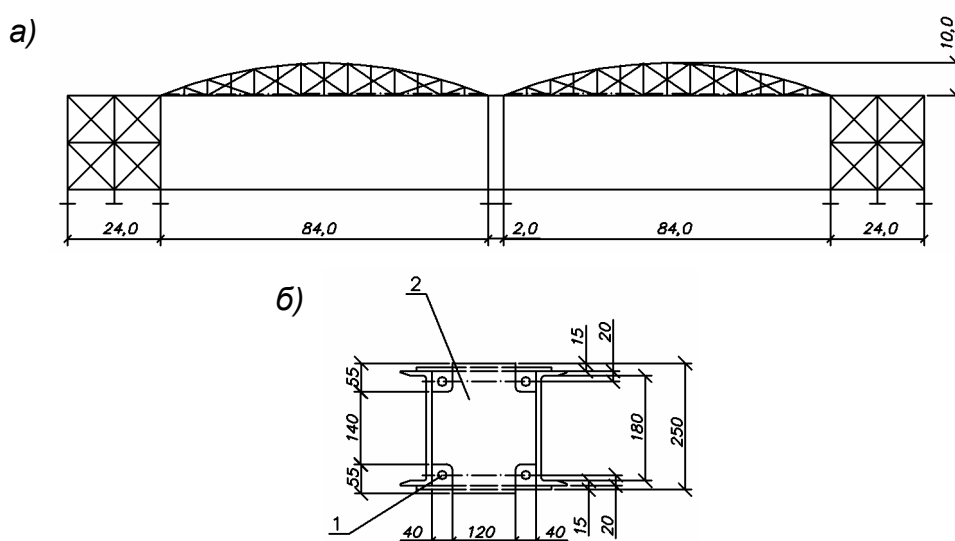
Стальные фермы (а – размеры в м) покрытия ангара в аэропорту Алма-Ата и сечение нижнего пояса (б – размеры в мм): 1 – напрягаемая арматура, 2 – диафрагма жесткости
